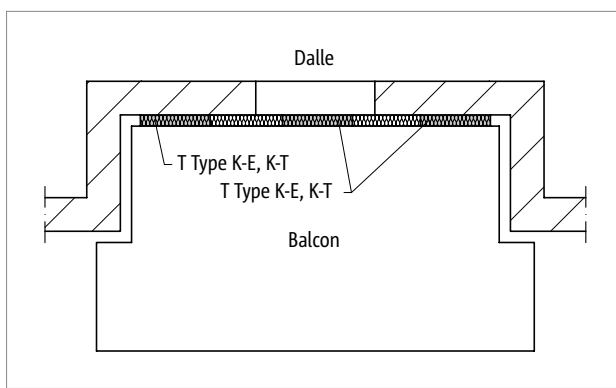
Schöck Isokorb® T Type K-E, K-T : Balcon avec retrait de façade
